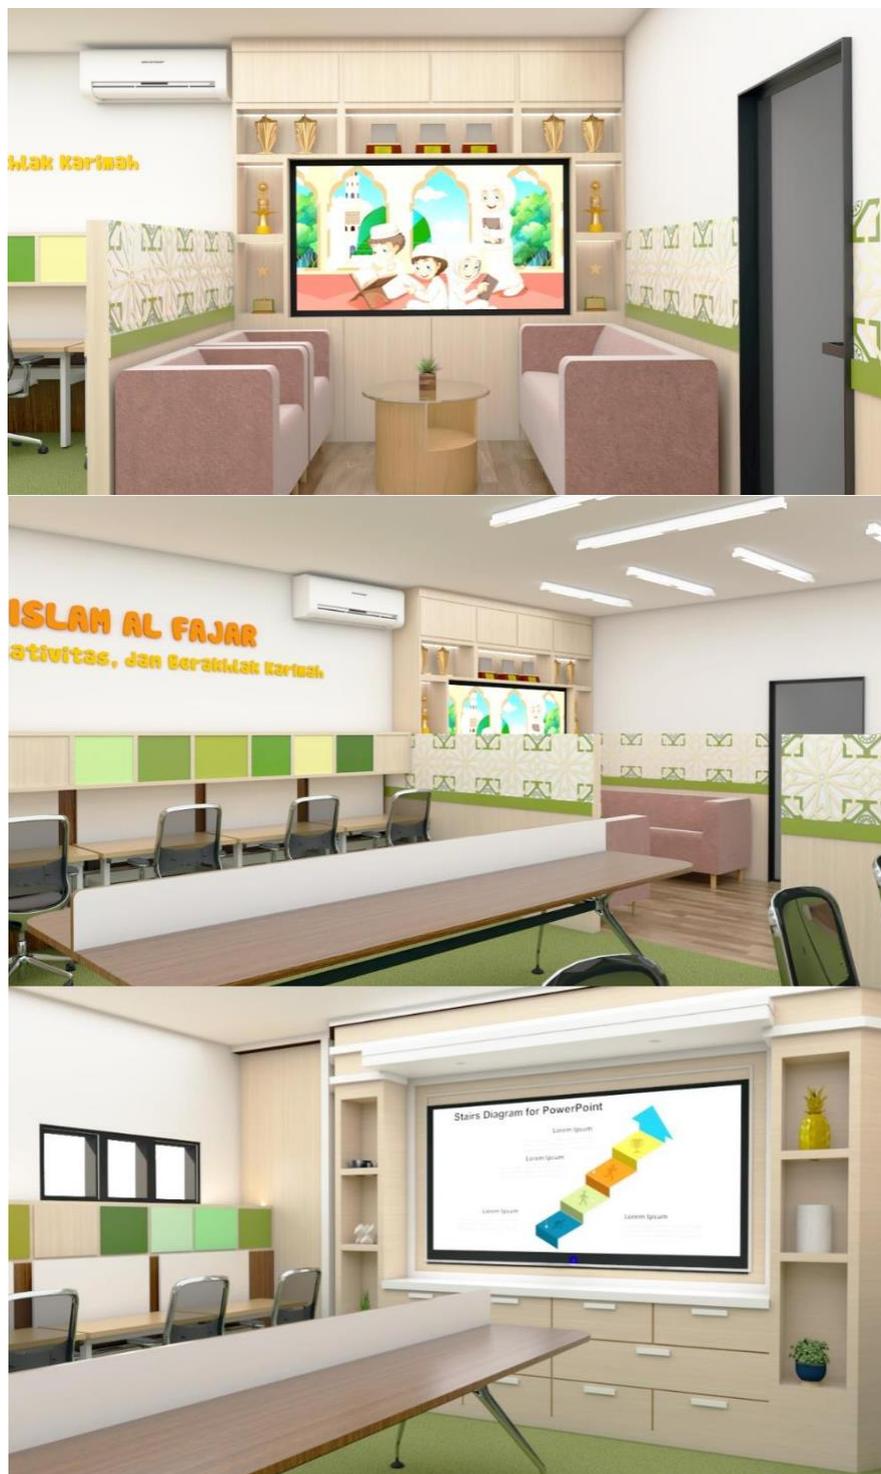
14 Layout ruang guru dan Kepala Sekolah
